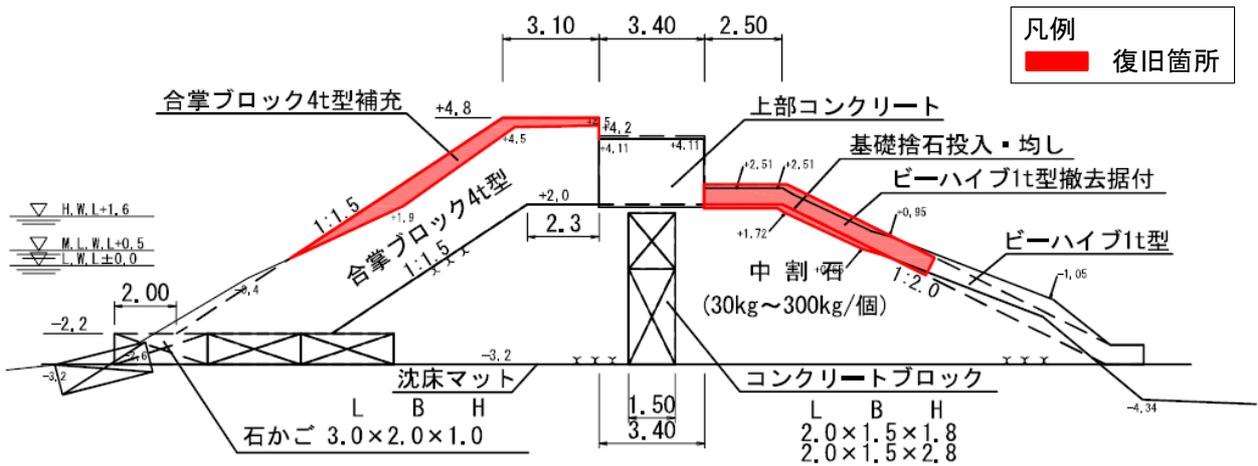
No.1 防波堤（東）の断面図 A-2 部（A-2-3）（復旧後）
